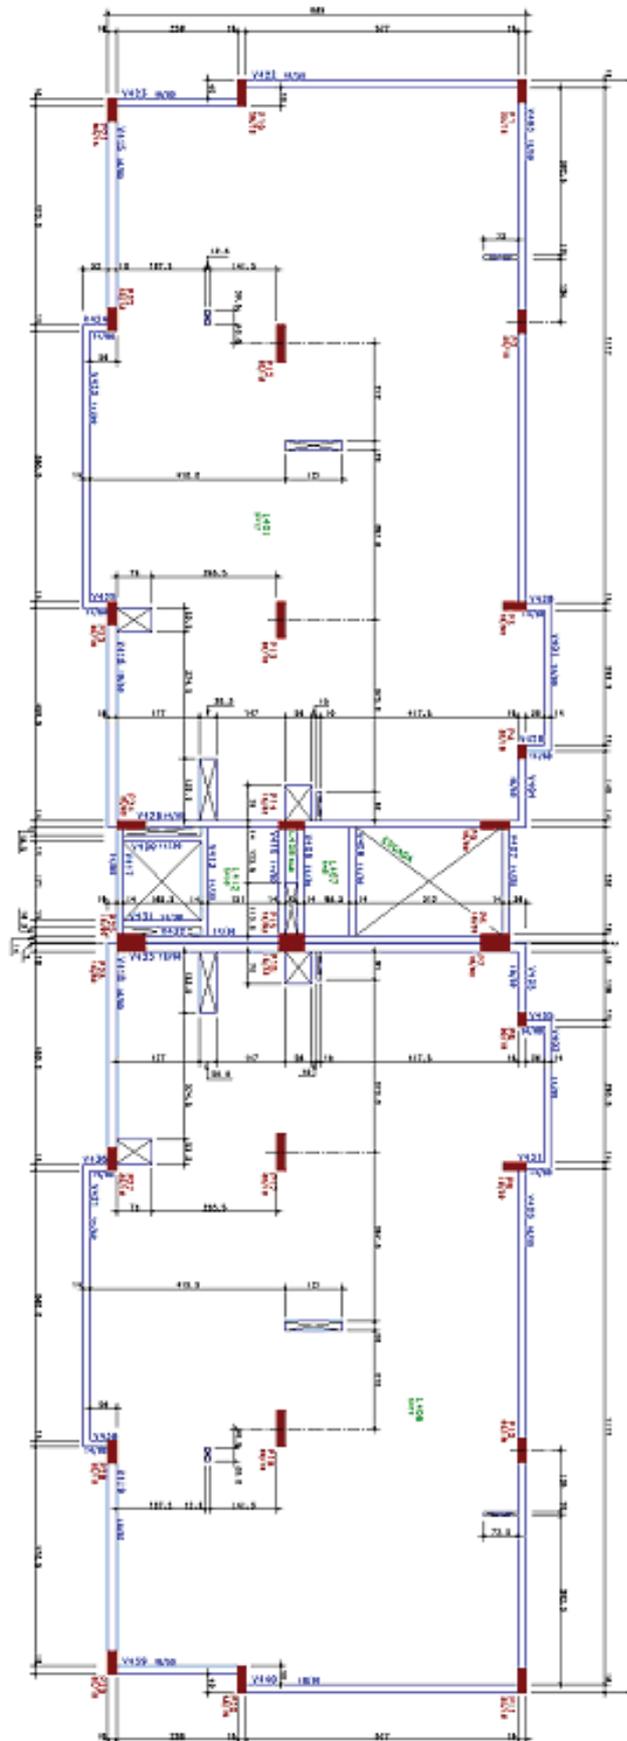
planta de fôrmas completa do pavimento tipo em laje lisa
